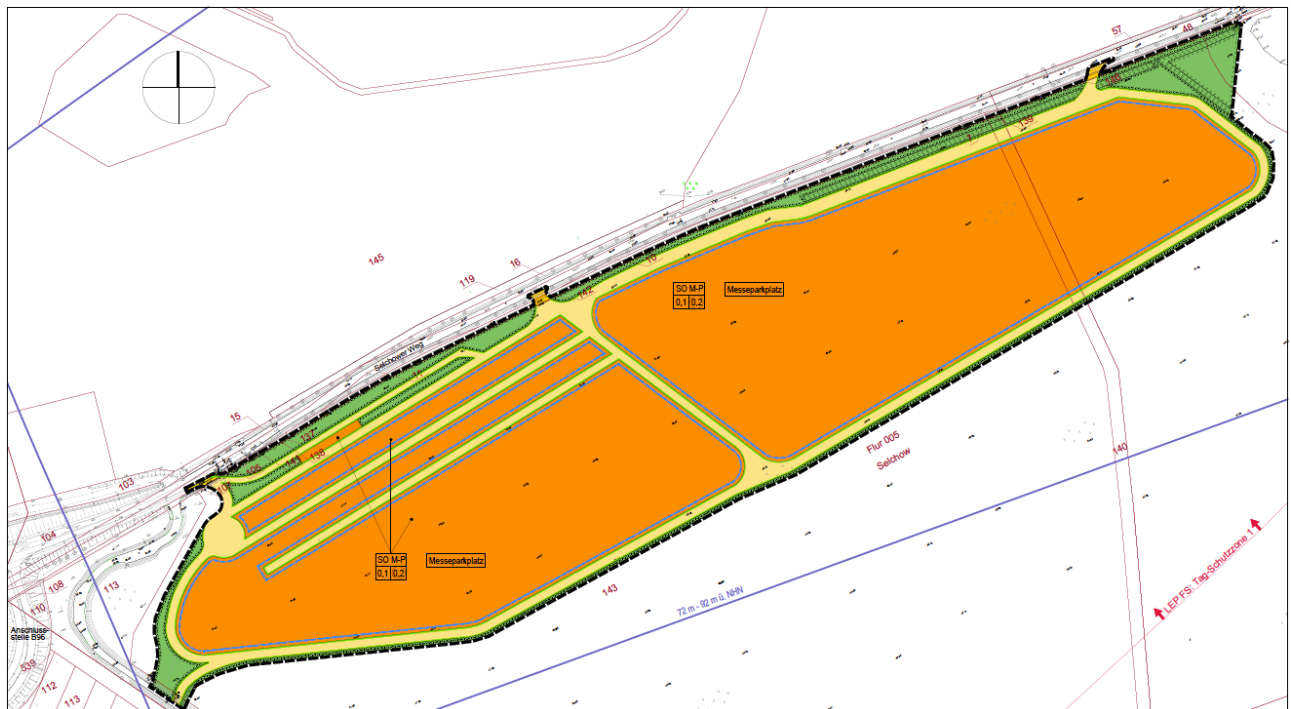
Bebauungsplan 04/25 „Messeparkplatz Selchower Weg / LPG-Straße“ (Vorentwurf, Stand 12/2025)
